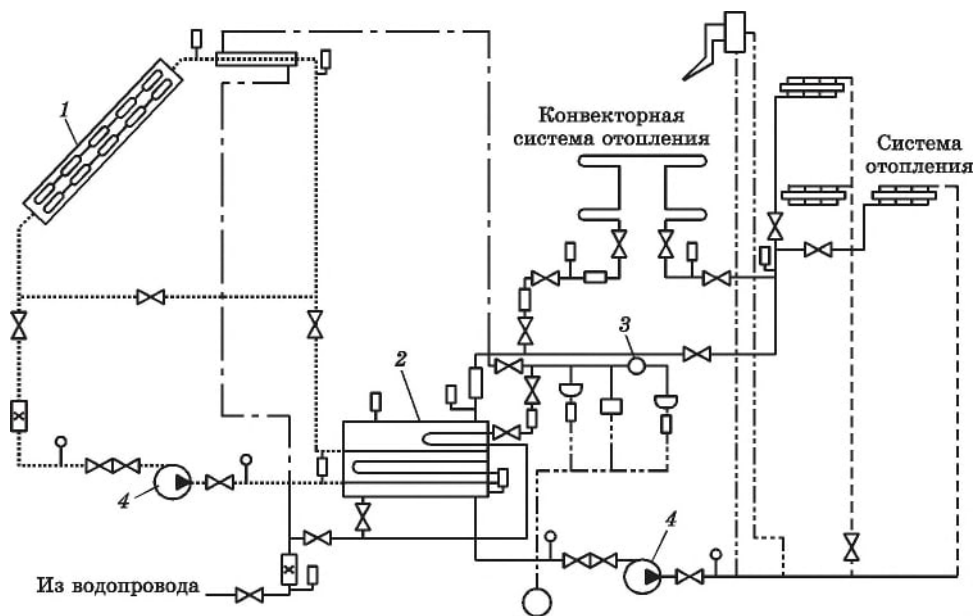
Принципиальная схема системы теплоснабжения жилого дома:
